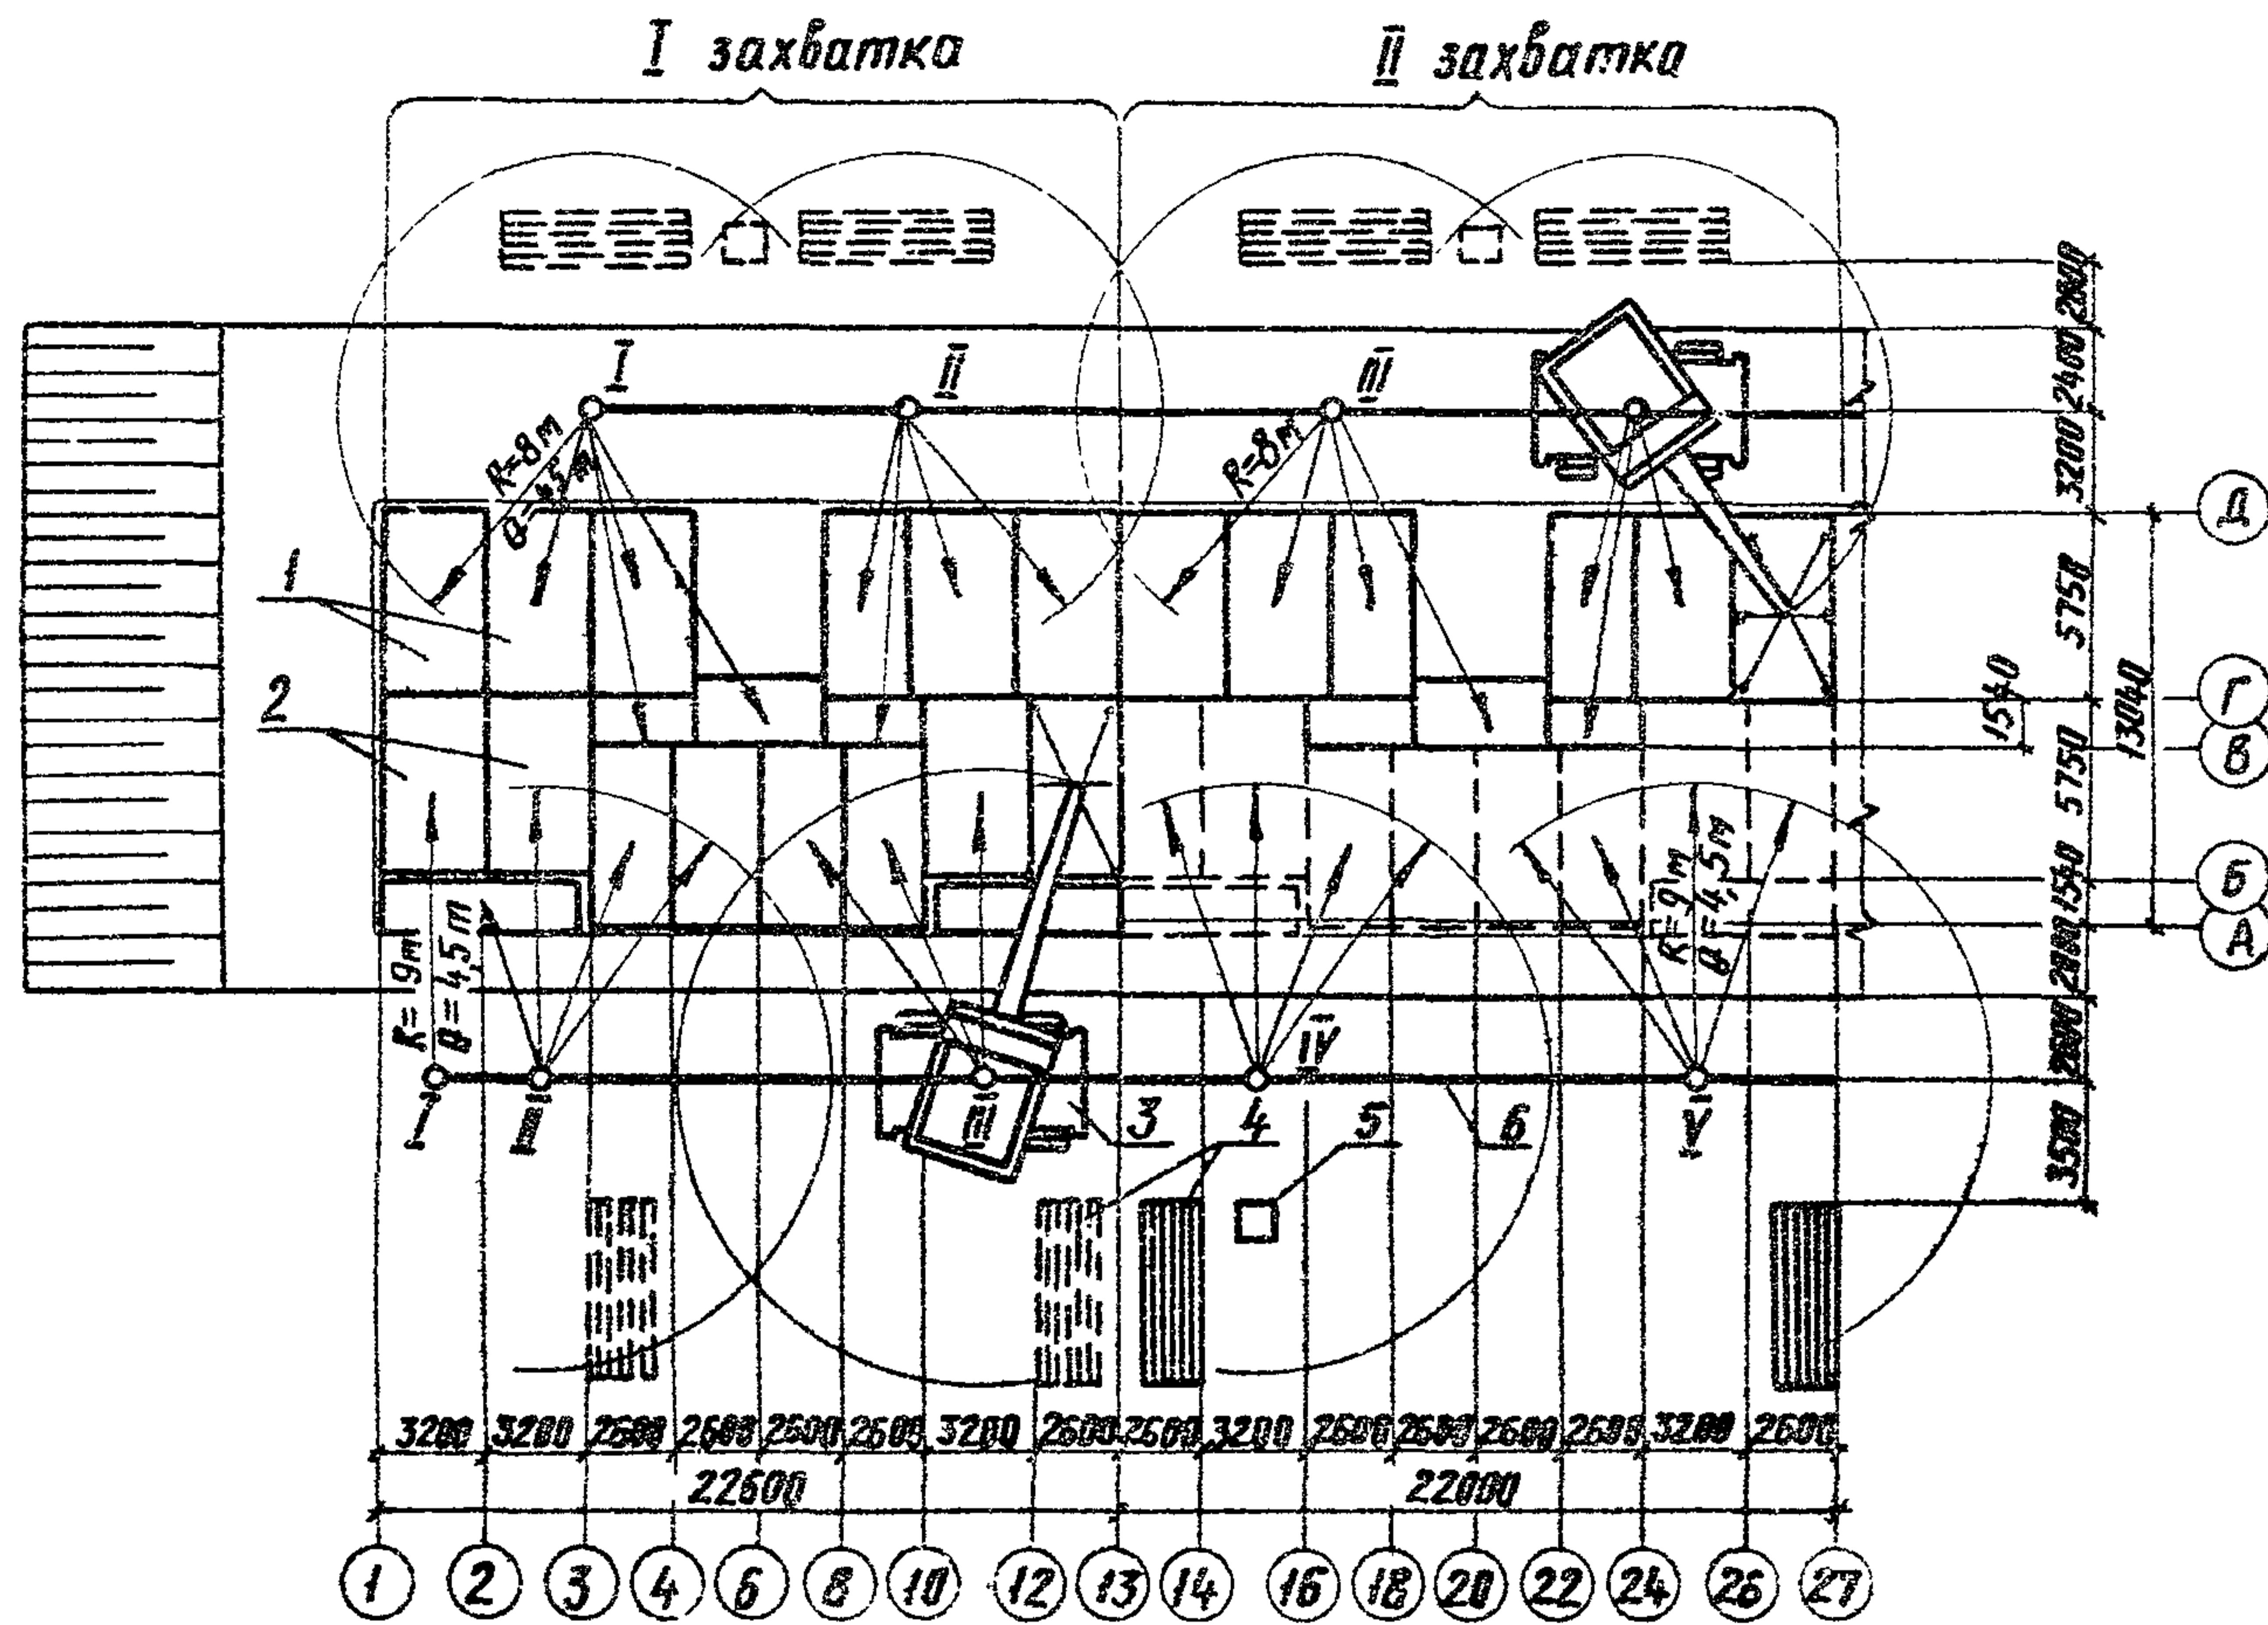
Схема организации работ по монтажу панелей перекрытия технического подполья: 1-панели смонтированные краном № 1; 2-панели смонтированные краном № 2; 3-пневмоцилиндрический кран К-161; 4-панели в кассетах; 5-ёмкость для раствора; 6-ось движения крана; I,II,III,IV,V-стойки крана
